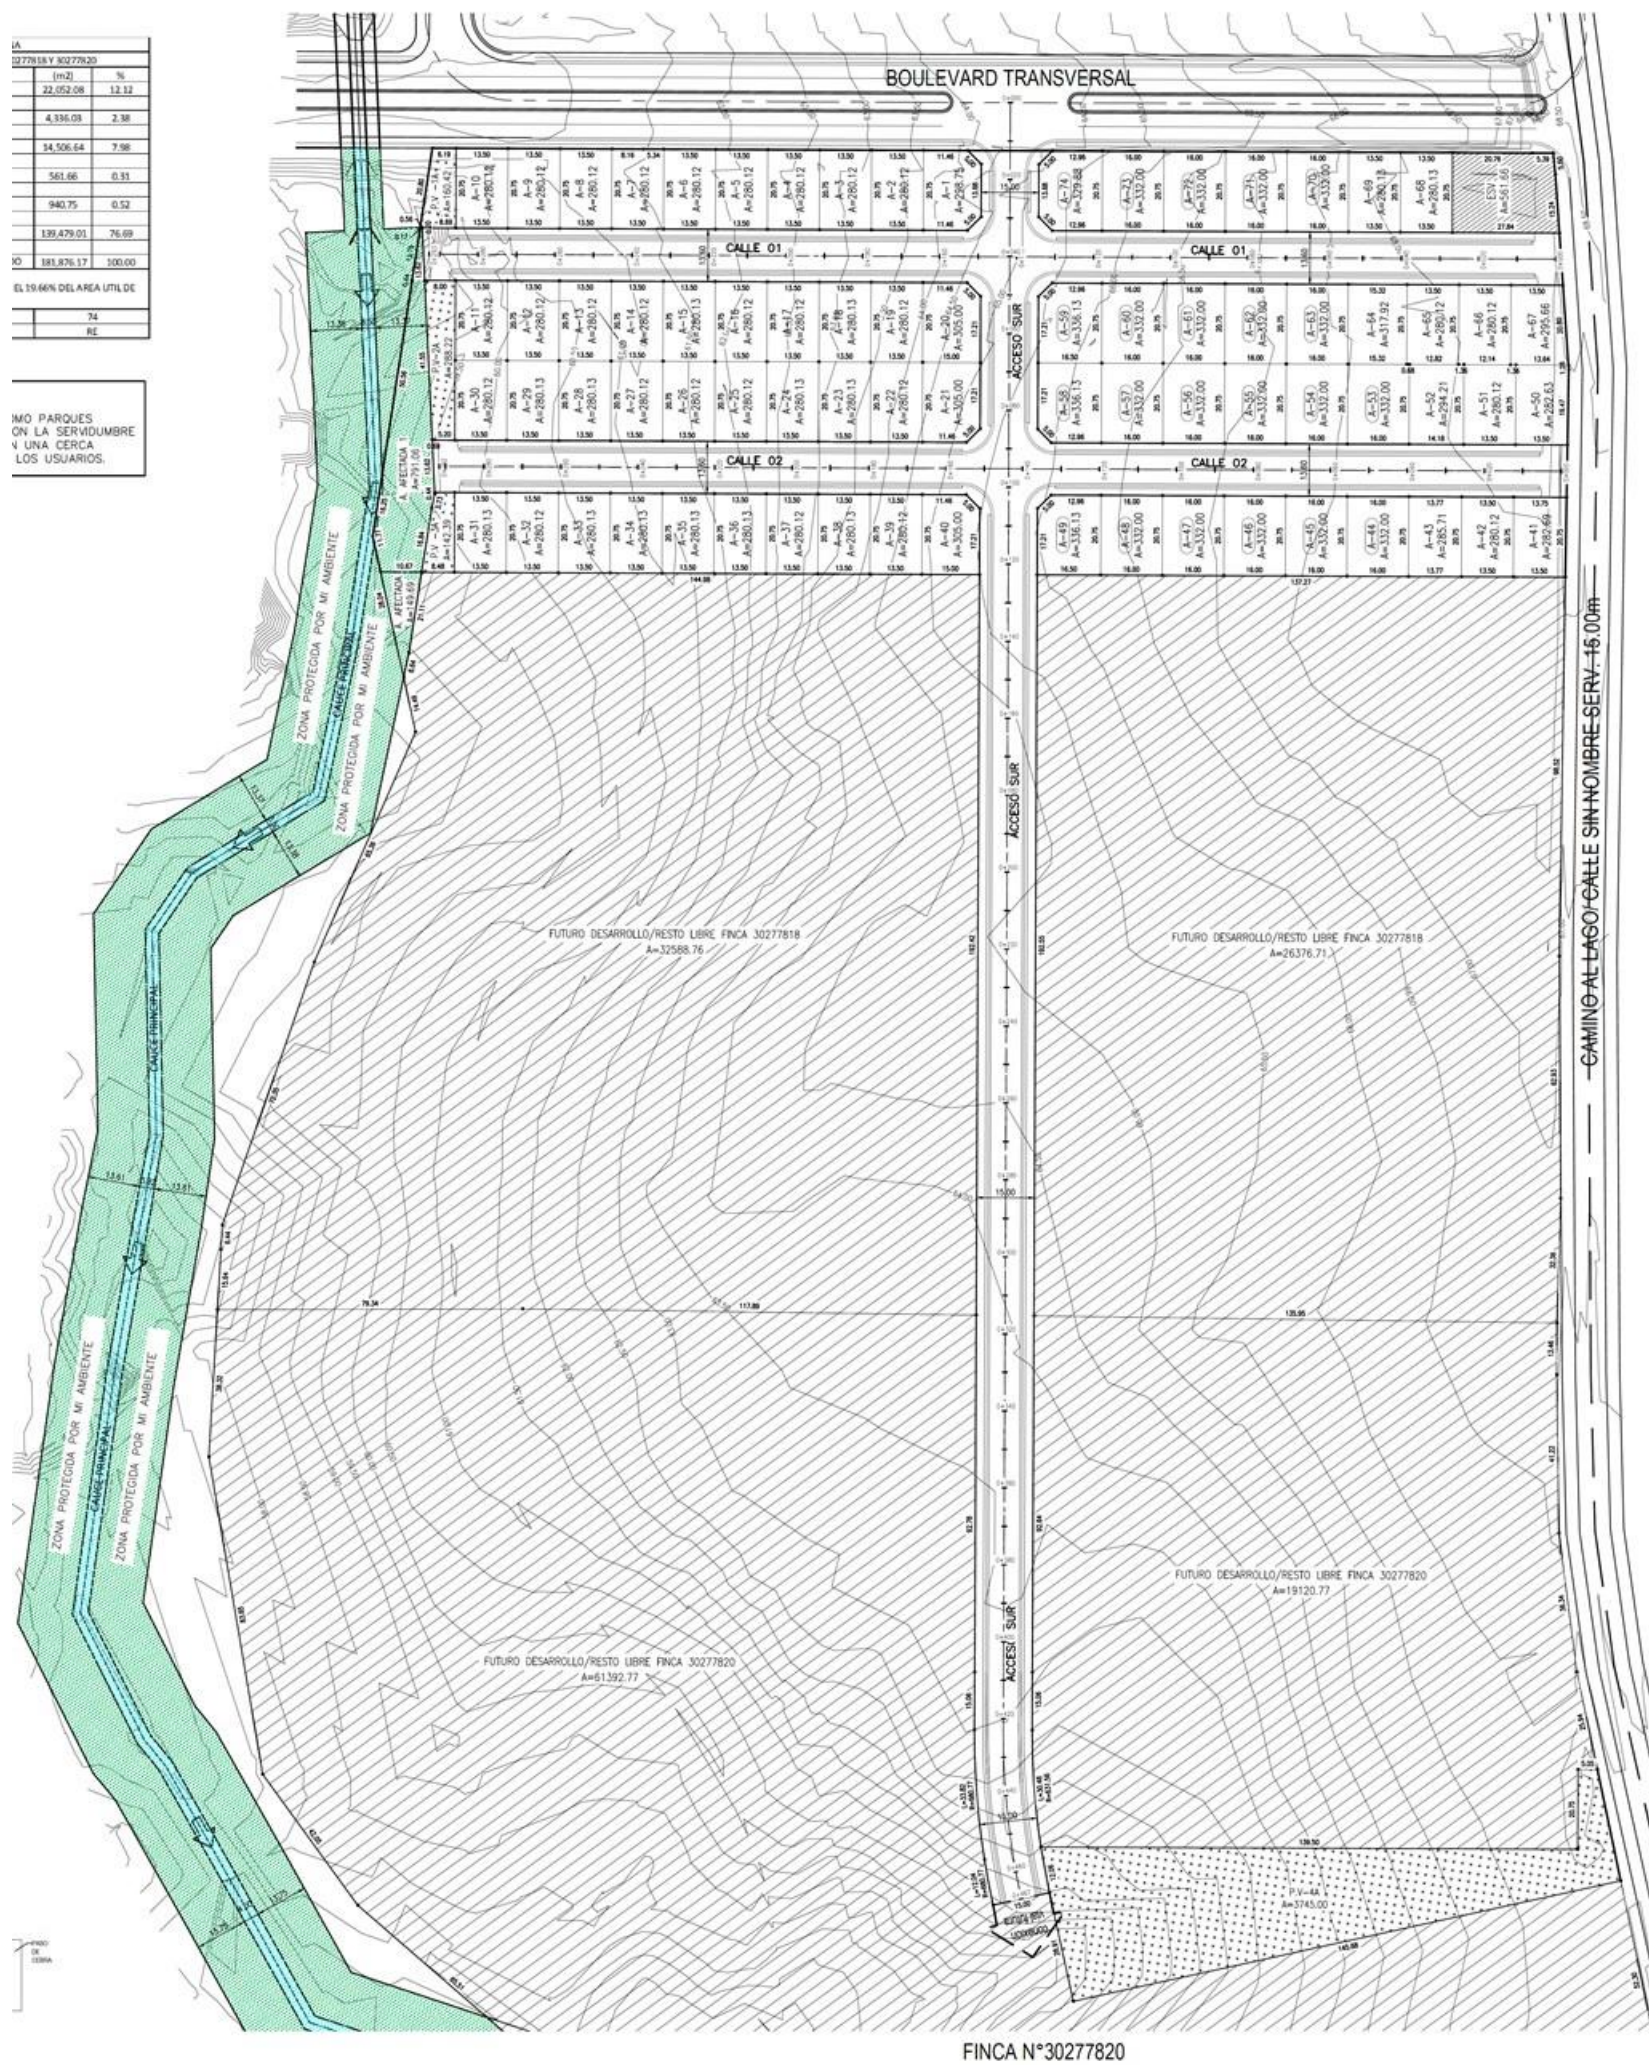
Vista general del sitio donde se construirá el proyecto “Residencial La Toscana – Etapa I”.
